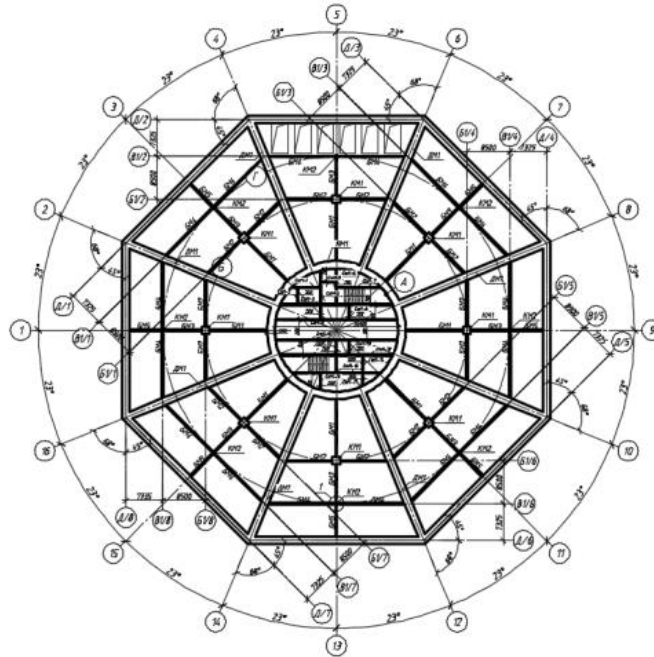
Конструктивна система залізобетонного перекриття з опиранням по контуру на монолітні балки
